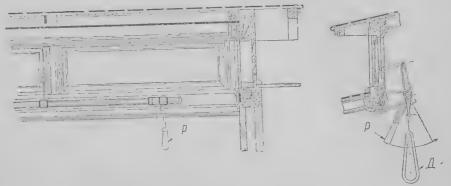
Световой фонарь: P — ручка механизма для открытия форточек, \mathcal{A} — держатель ременный.
